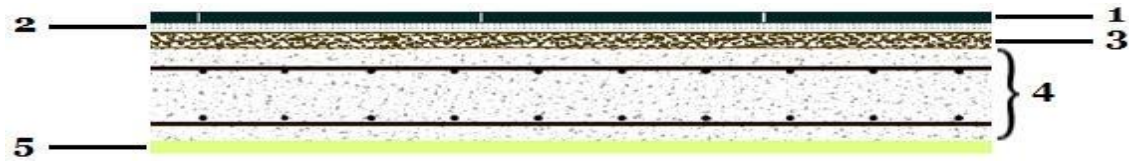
Coupe transversale d'un plancher à dalle pleine.
